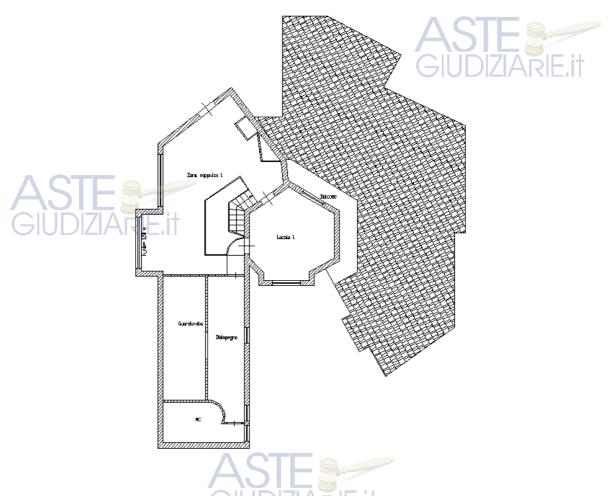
Planimetria della villa: Piano Primo: Fgl 110 p.lla 470 graf. alle p.lle 471, 473 e 493 sub 1
